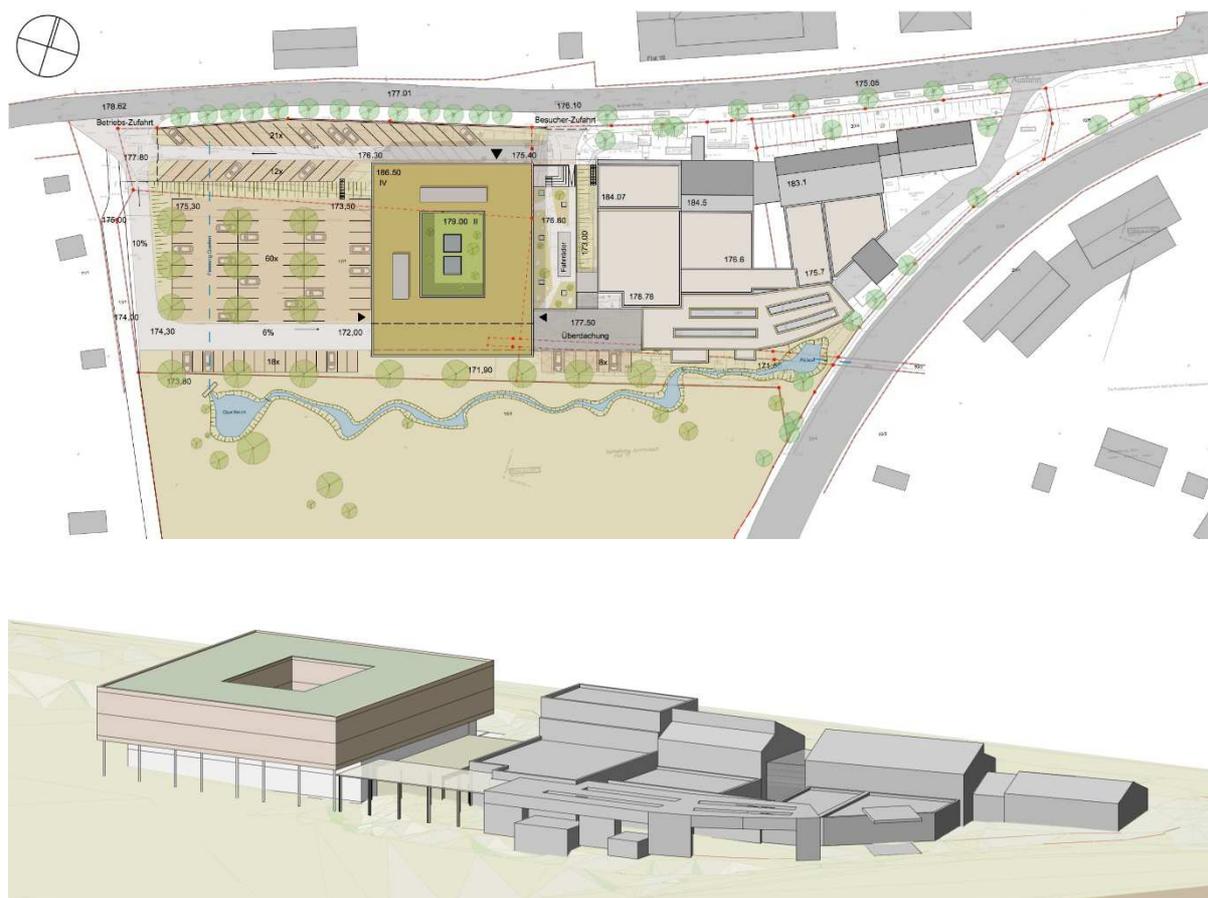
Oben: Lageplan geplanter Neubau Produktions- und Verwaltungsgebäude inkl. Erschließung mit ebenerdigen neuen Stellplatz, Unten: Ansicht von Südosten mit Neubau im Westen [li. im Bild], Bestandsbebauung im Osten [re. im Bild]
